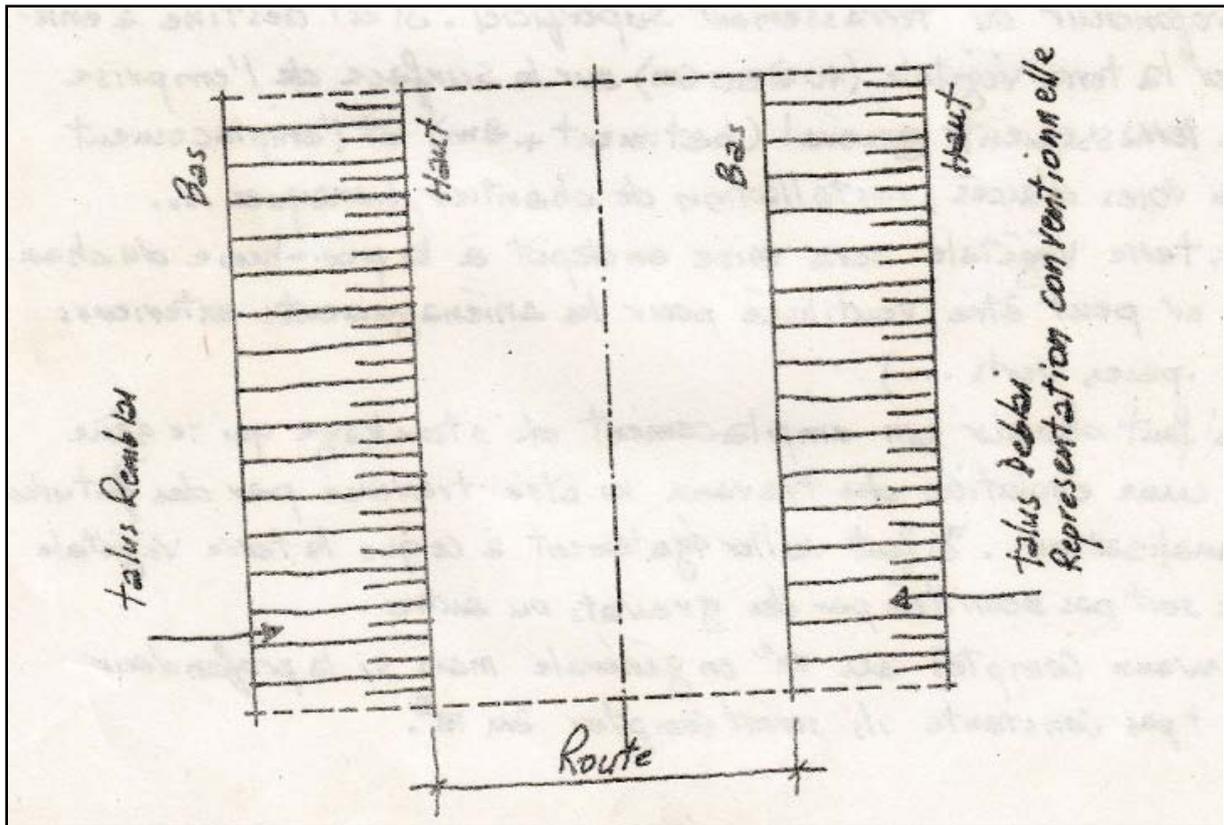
Schéma remblais et déblais en plan (vue en plan de figure 1)
